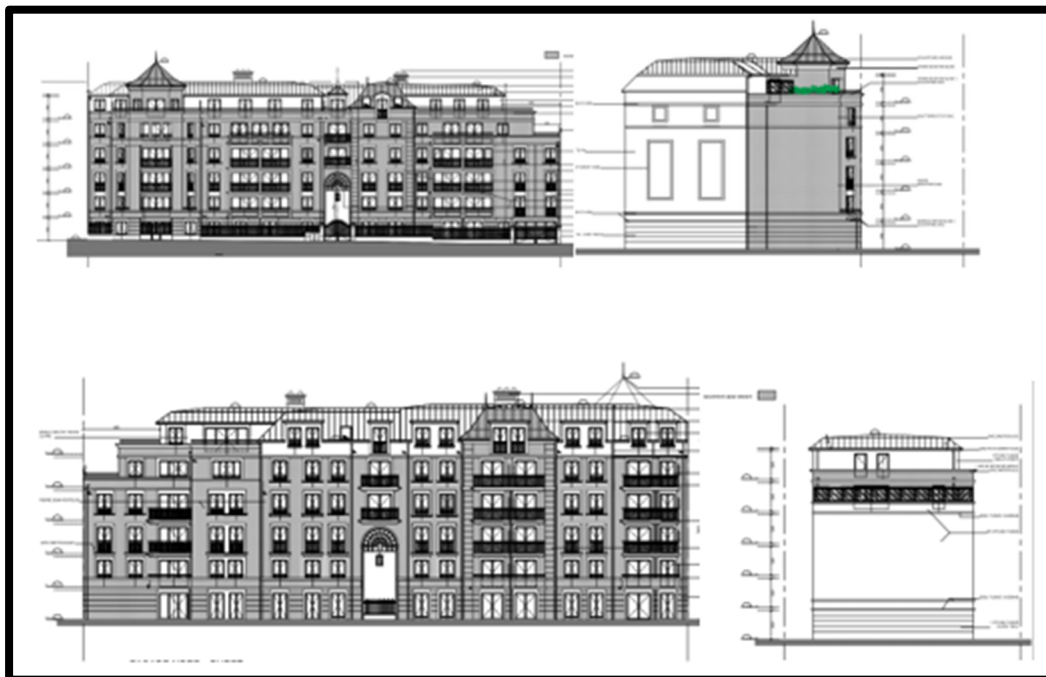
Fachadas do edifício de estudo (fase projeto)
